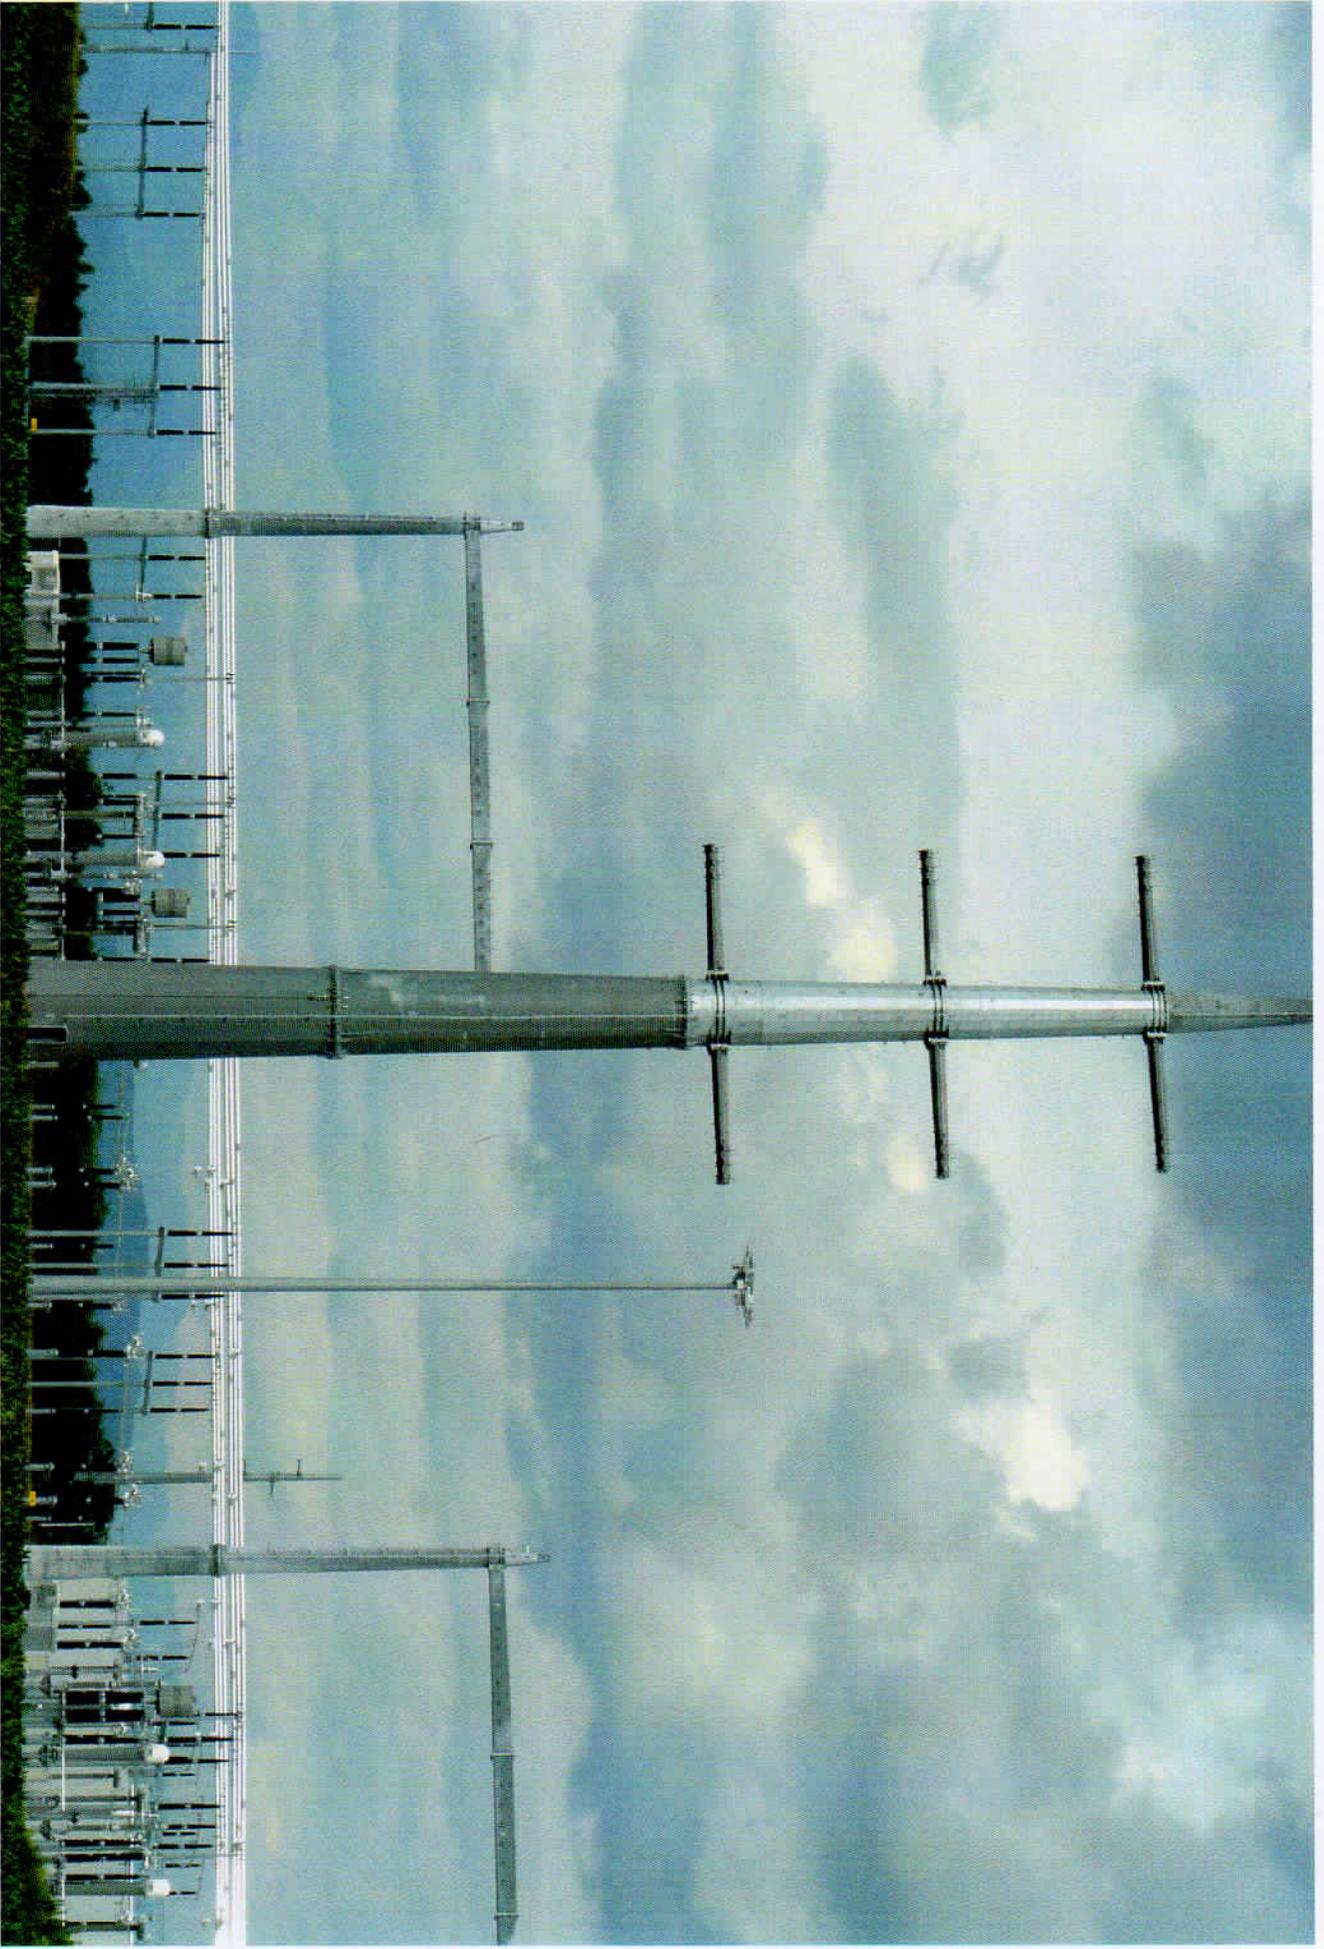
Vista aerea della stazione elettrica 380/220 kV di Udine Sud (lato sezione 220 kV)
